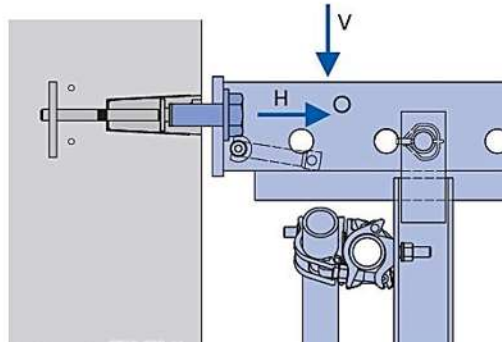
Fijación de la estructura de la cimbra al muro de concreto.
